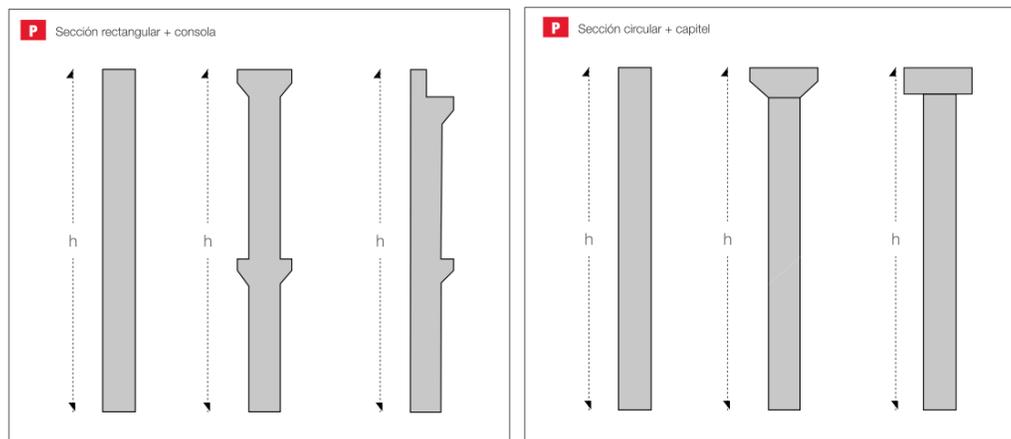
Tipos de columnas prefabricadas de hormigón
